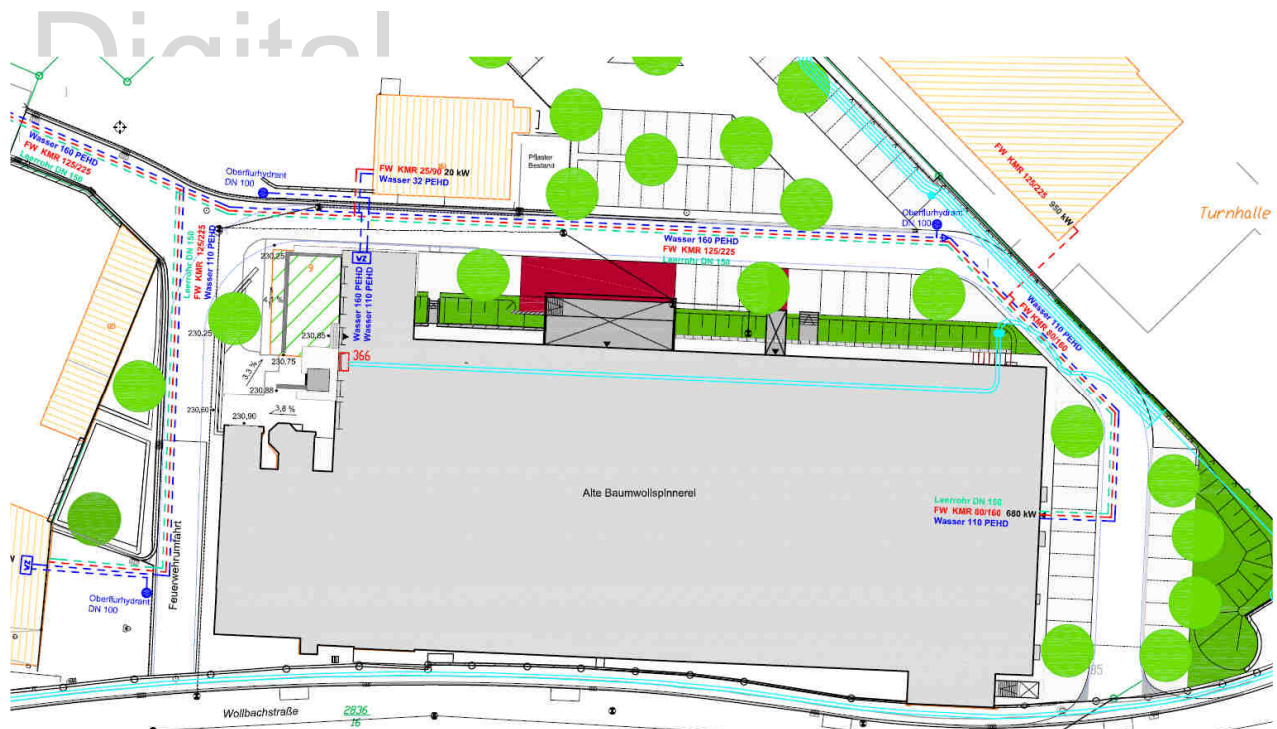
Übersicht Lageplan Versorgungsleitungen (Dienstbarkeiten)
